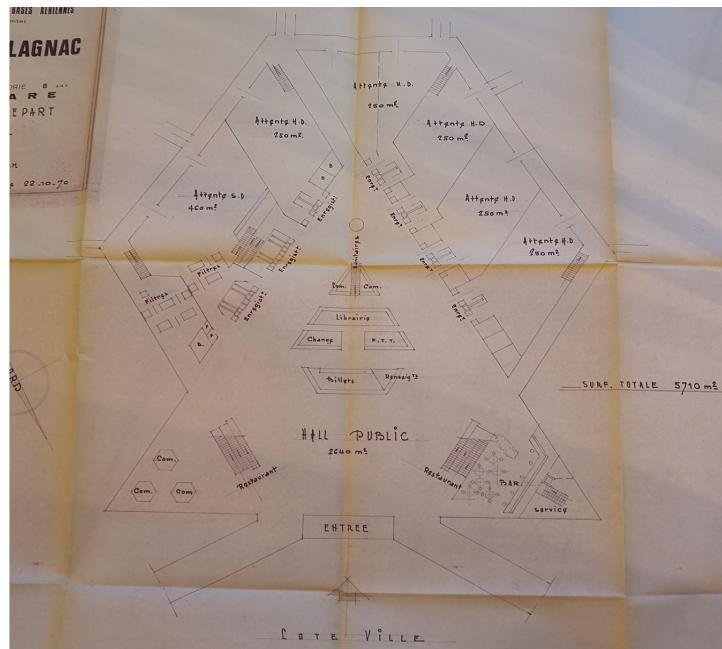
c) : Plan niveau restaurant - Projet C, aérogare de Toulouse-Blagnac 2, maître d'œuvre : STBA, s.d.
